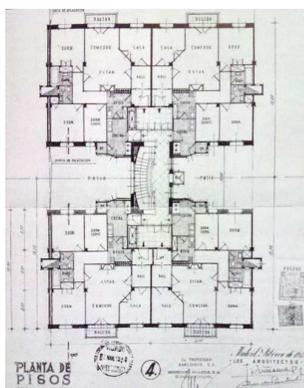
Bloque de vivienda bonificable en la calle O'Donnell, Madrid. Planta de vivienda, 1949.
